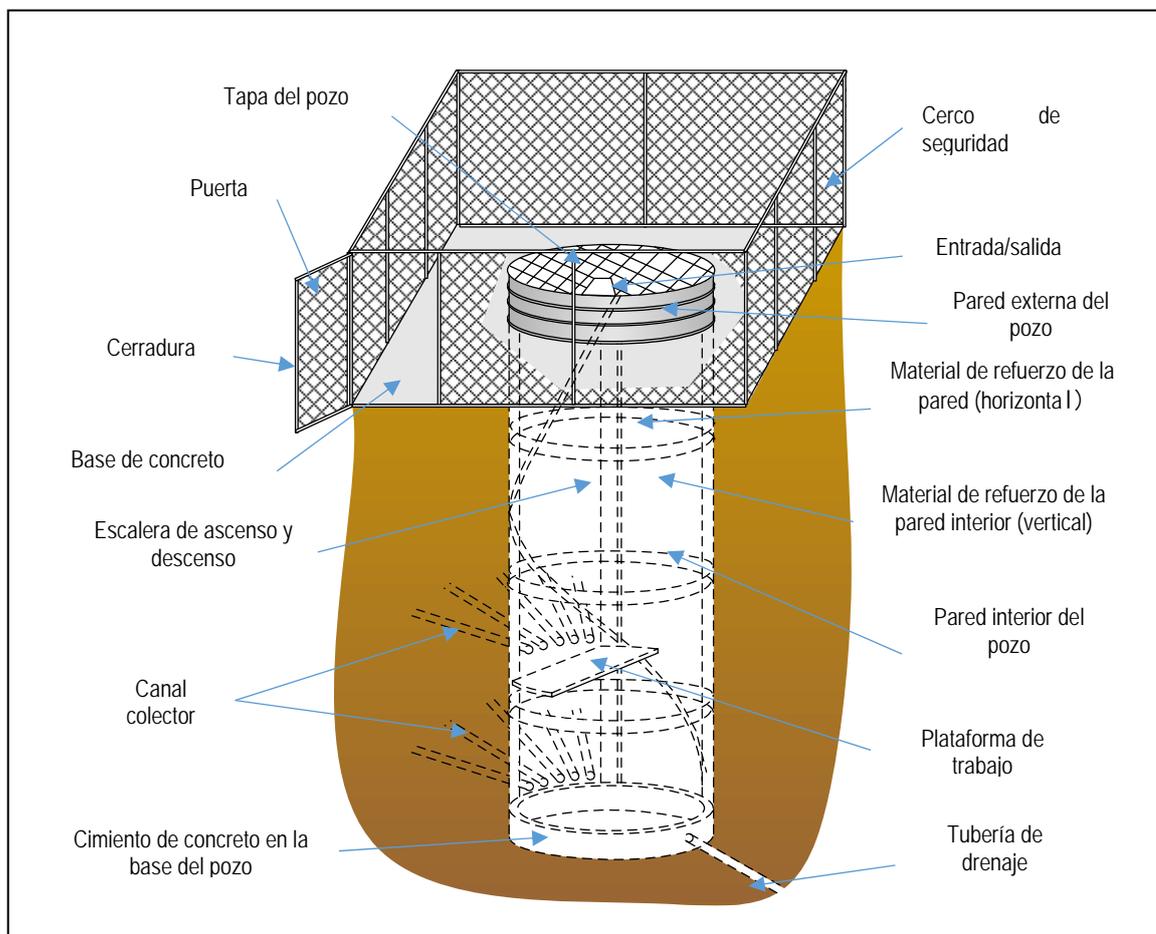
Instalaciones accesorias del pozo de drenaje (Fuente: JCT)
